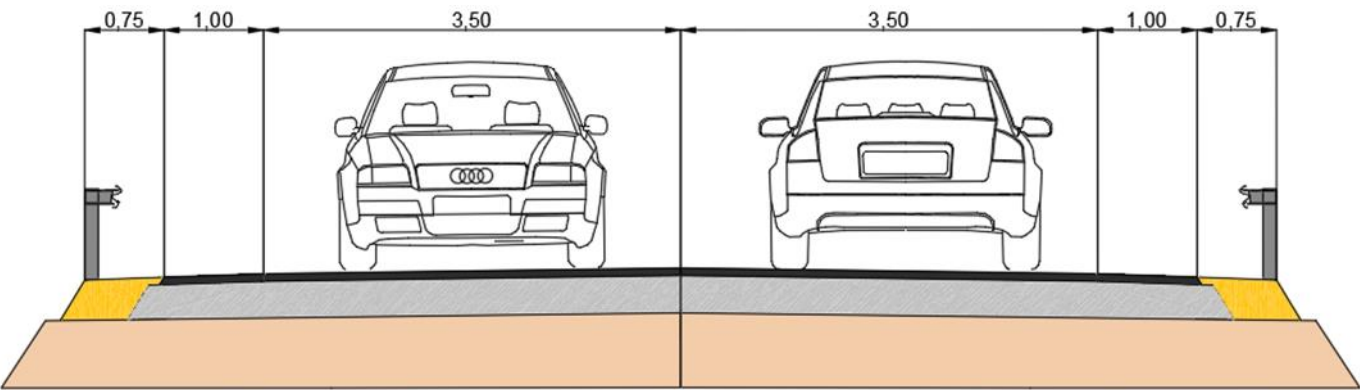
Sección transversal de la nueva calzada del tramo 1. (Fuente: Elaboración propia)
